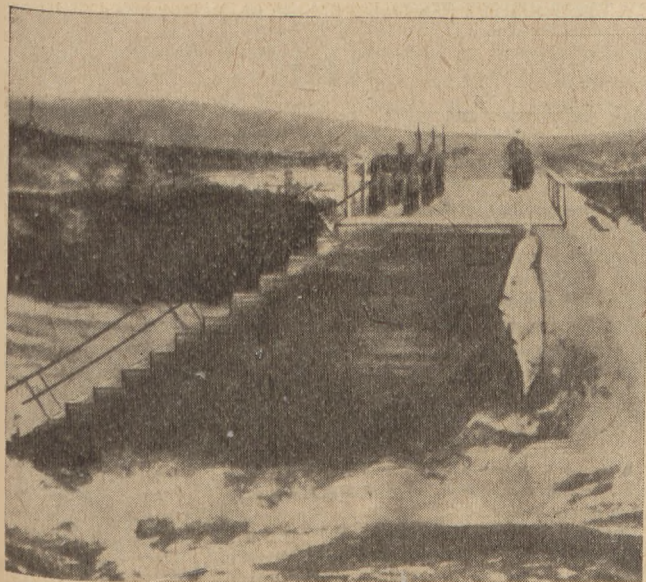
Wadliwa konstrukcja przelewu zapory ziemnej (Melville)
